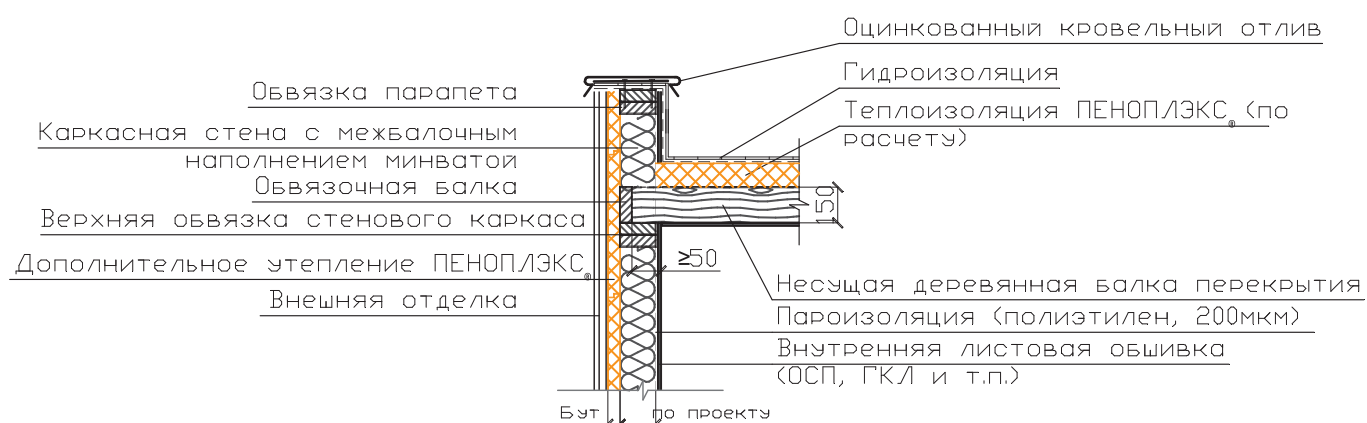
Схема примыкания теплоизолированной каркасной стены к конструкции плоской кровли.
